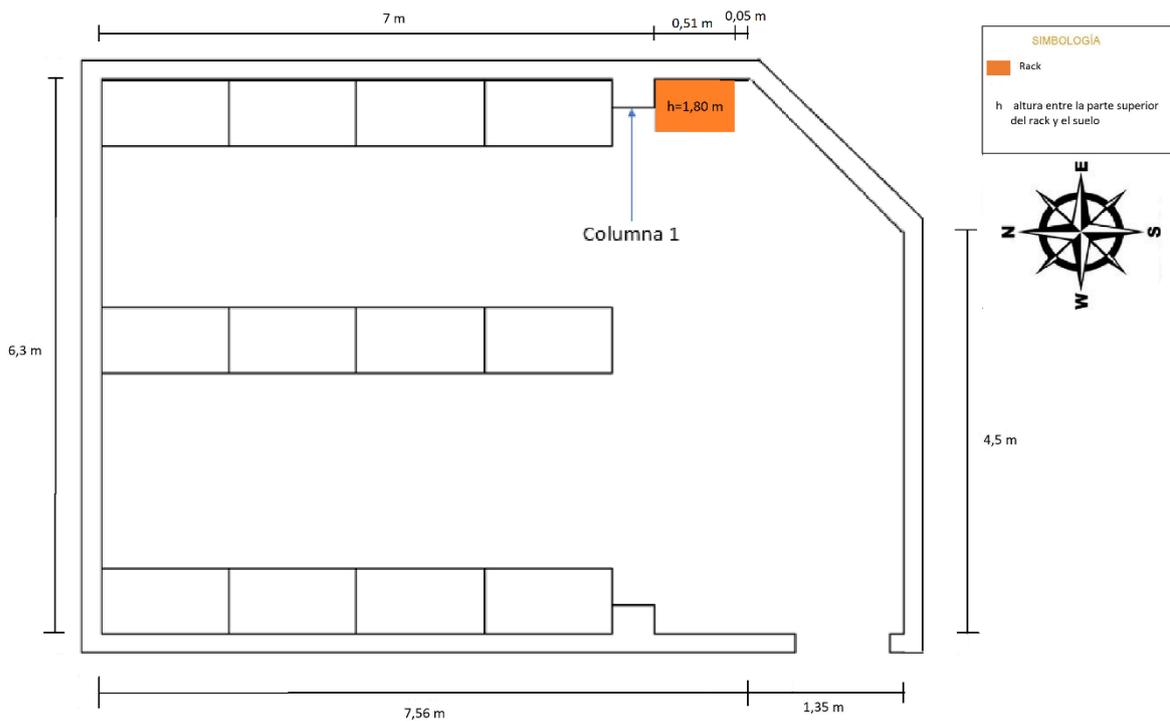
Plano del Rack Dentro del Laboratorio
